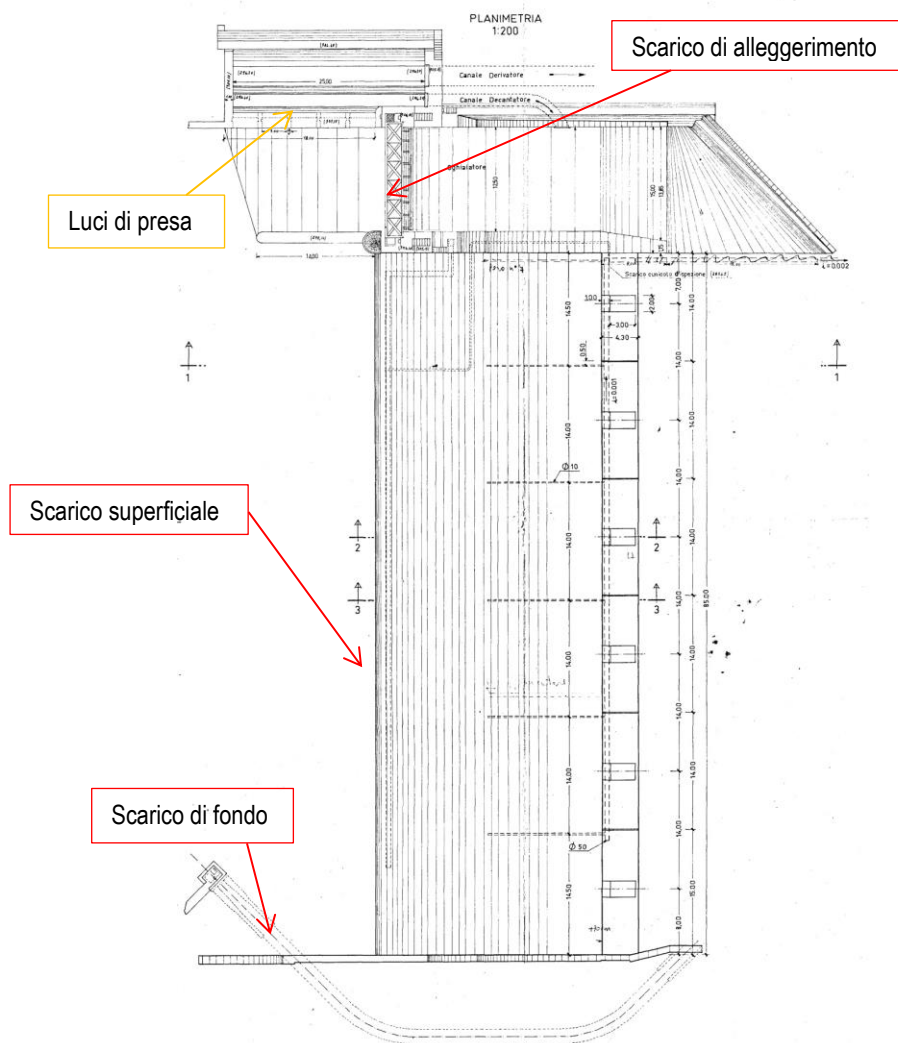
Planimetria dello sbarramento di Ortiglieto con individuazione di scarichi e opera di presa.
